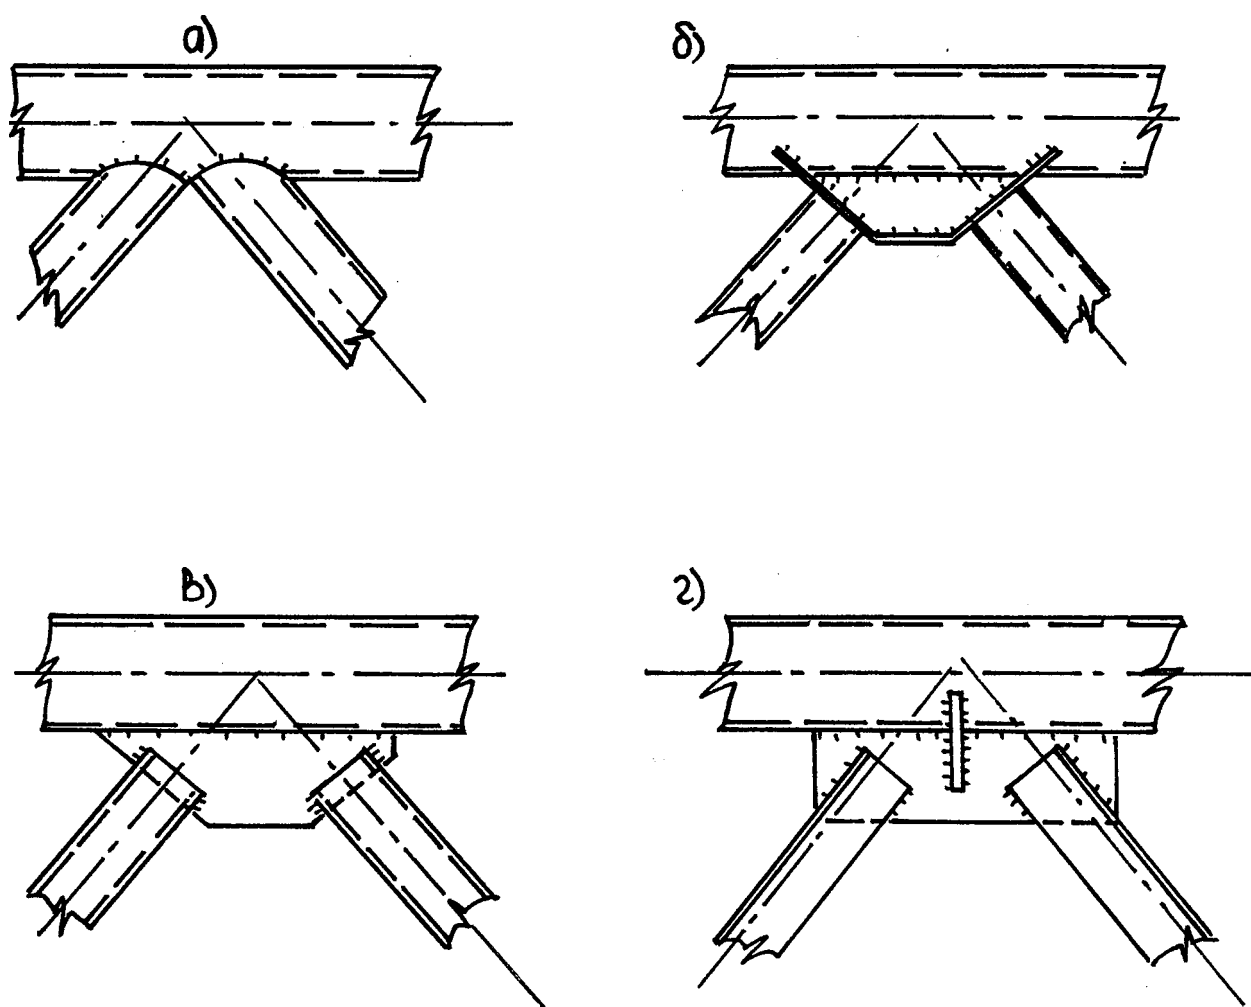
Примыкание раскосов к верхнему сжатому трубобетонному поясу:
